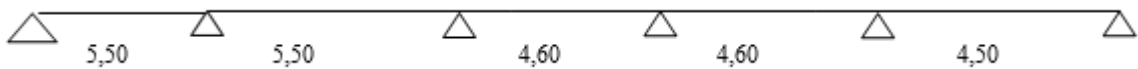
Schéma statique de la poutrelle a 5 travées.
